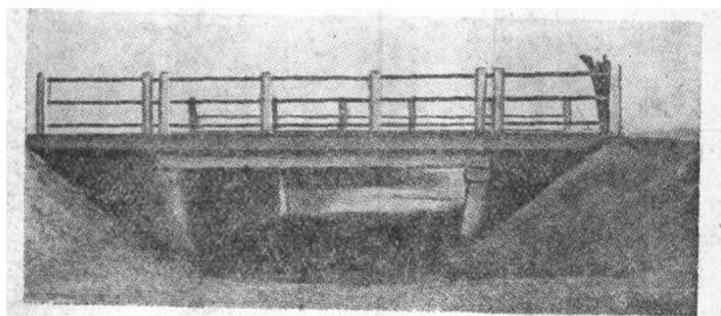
架在混凝土橋台上的鋼筋混凝土版式橋
